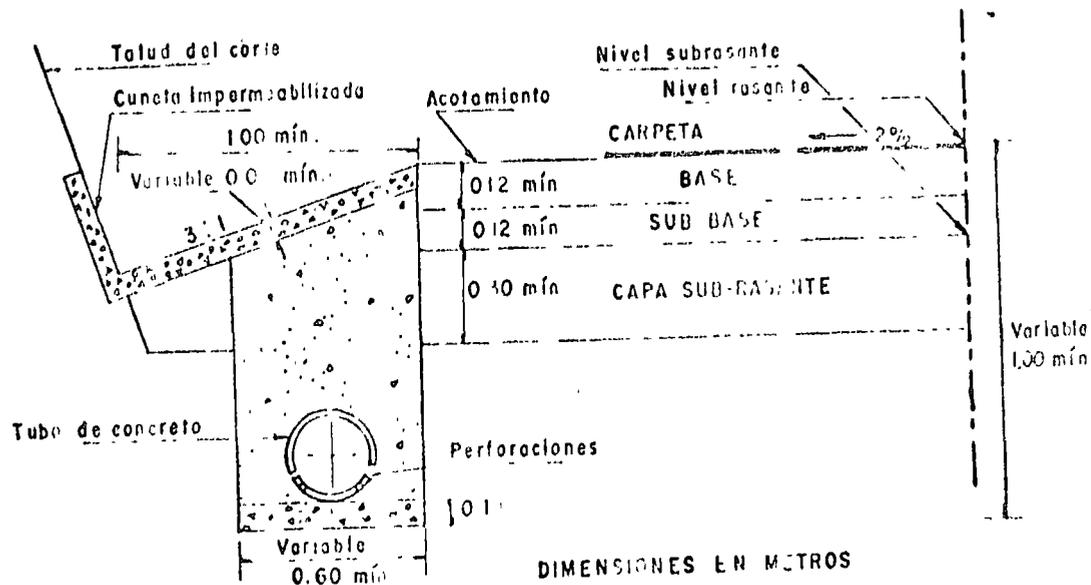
Sección transversal de un subdrén longitudinal de zanja según la práctica mexicana. (Secretaría de Obras Públicas).
